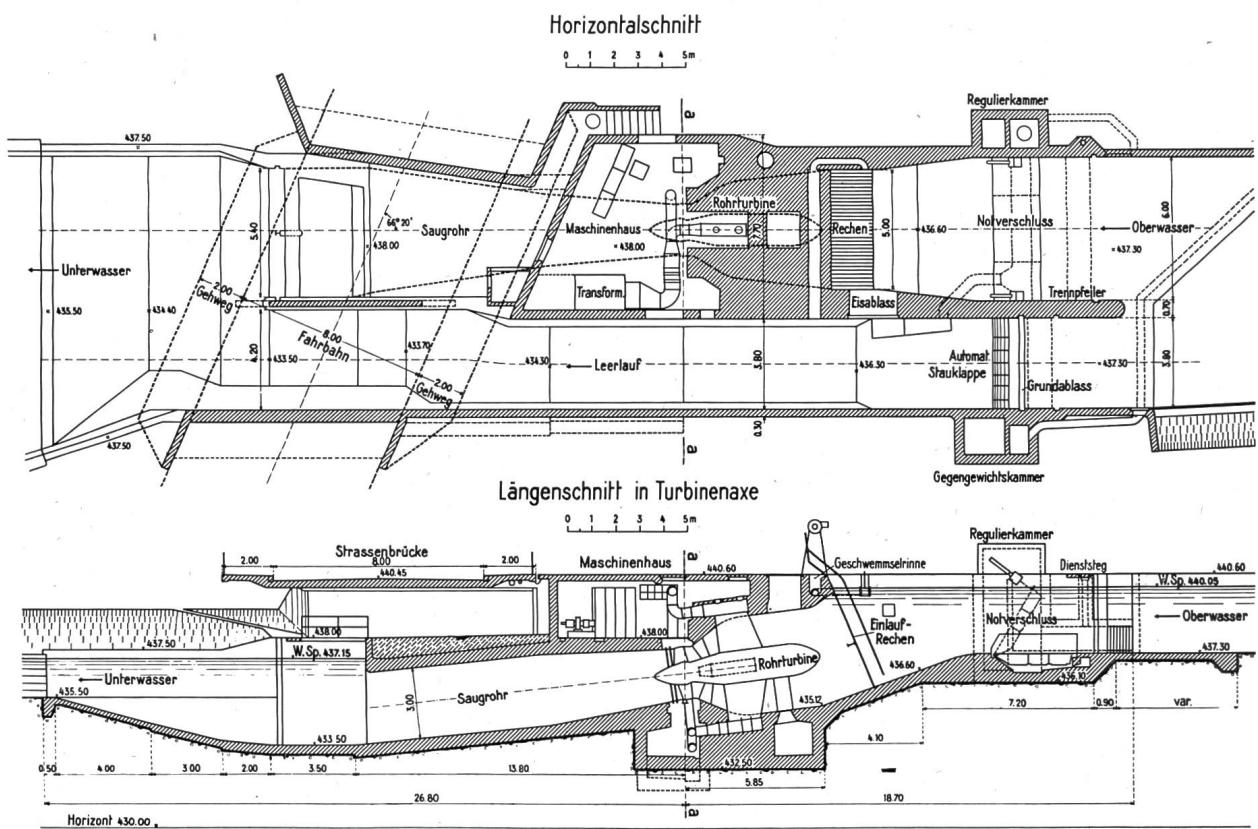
Längsschnitt und Lageplan des Rohrturbinenkraftwerkes Bürglen/«Säge»
